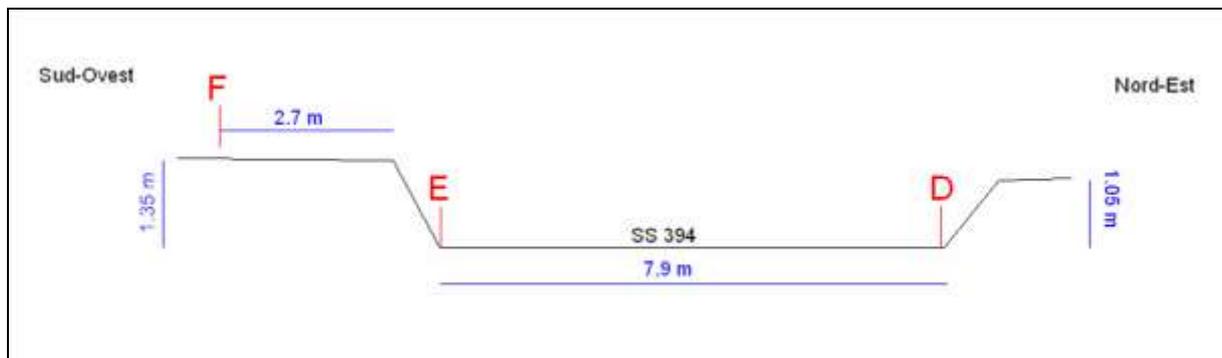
Sezione schematica del tratto stradale di interesse (SS 394)
